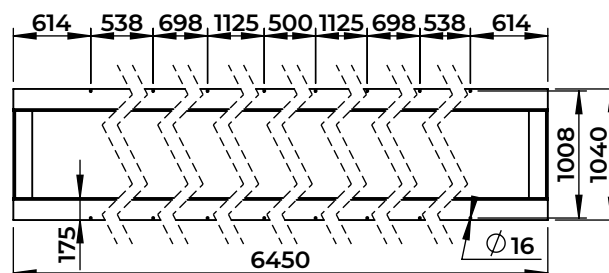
Abmessungen und Einbaupositionen für Stahlfundament
